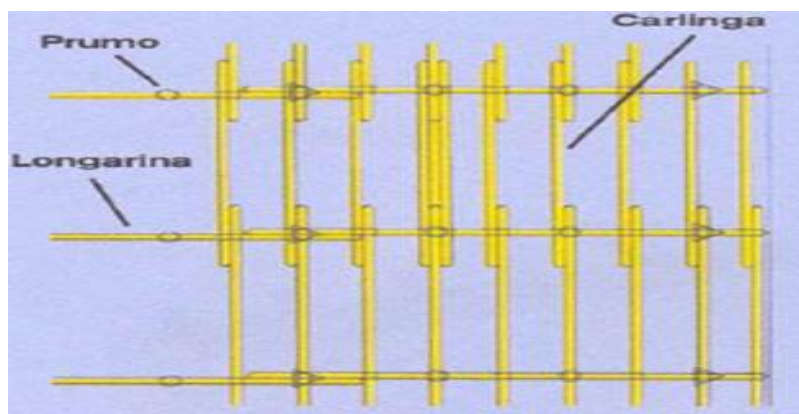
Decomposição dos sistemas racionais para execução de lajes [8]
